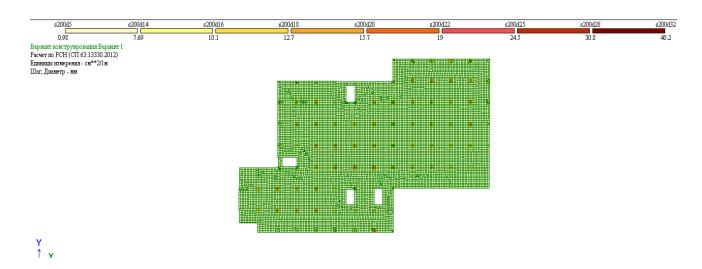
Площадь арматуры на 1 п.м по оси X у верхней грани
